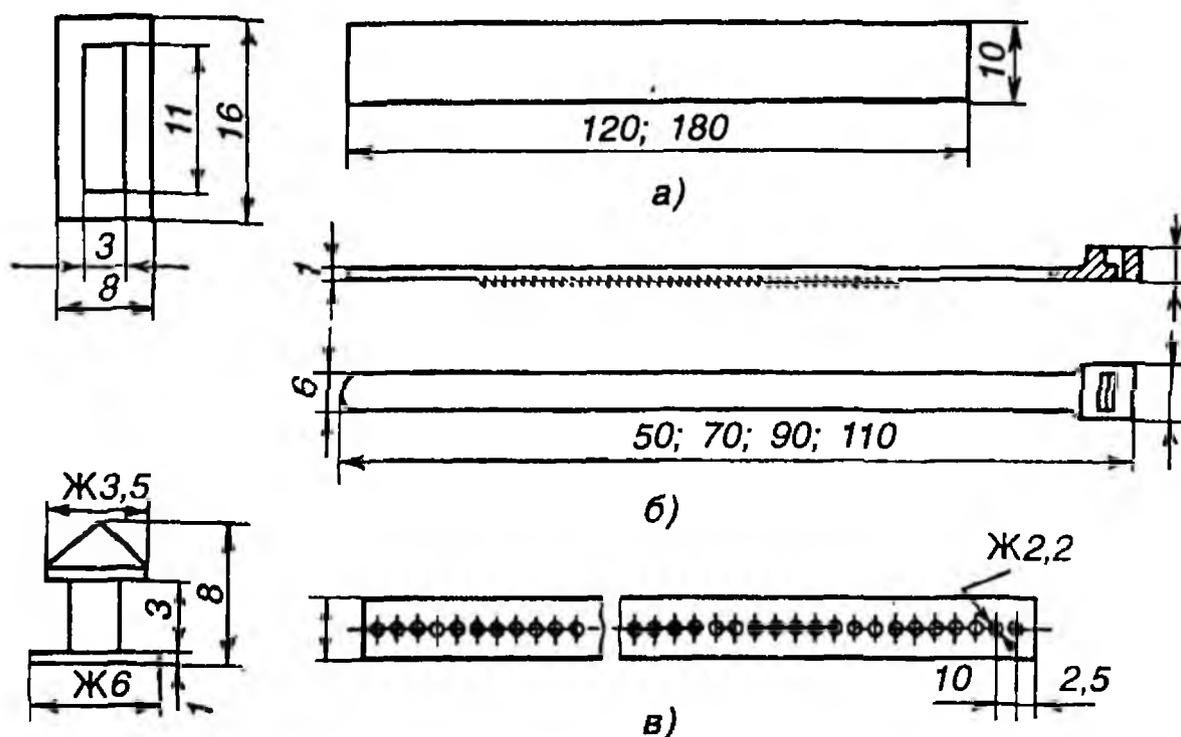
Изделия для крепления проводов, труб и кабелей:
